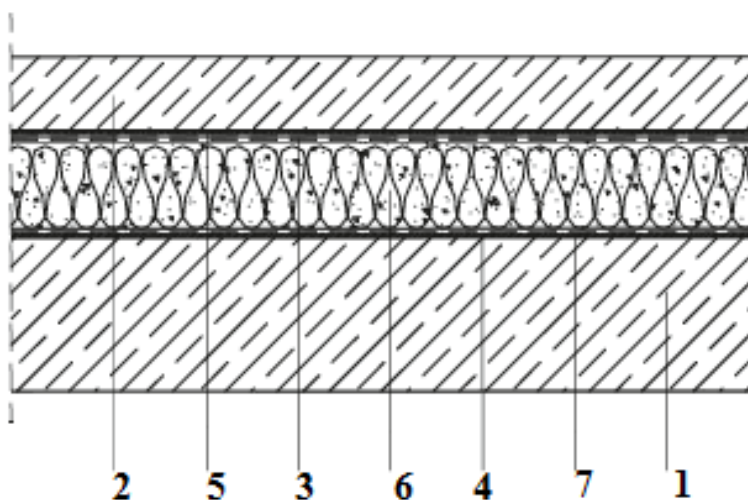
Конструкция с бетонной распределительной плитой: 1 — железобетонное перекрытие; 2 — бетонная распределительная плита; 3 — гидроизоляция кровли, 2-слойная; 4 — кровельный материал, предотвращающий диффузию; 5 — разделительный или защитный слой; 6 — изоляция плоской кровли Multipor DAA; 7 — грунтовка
